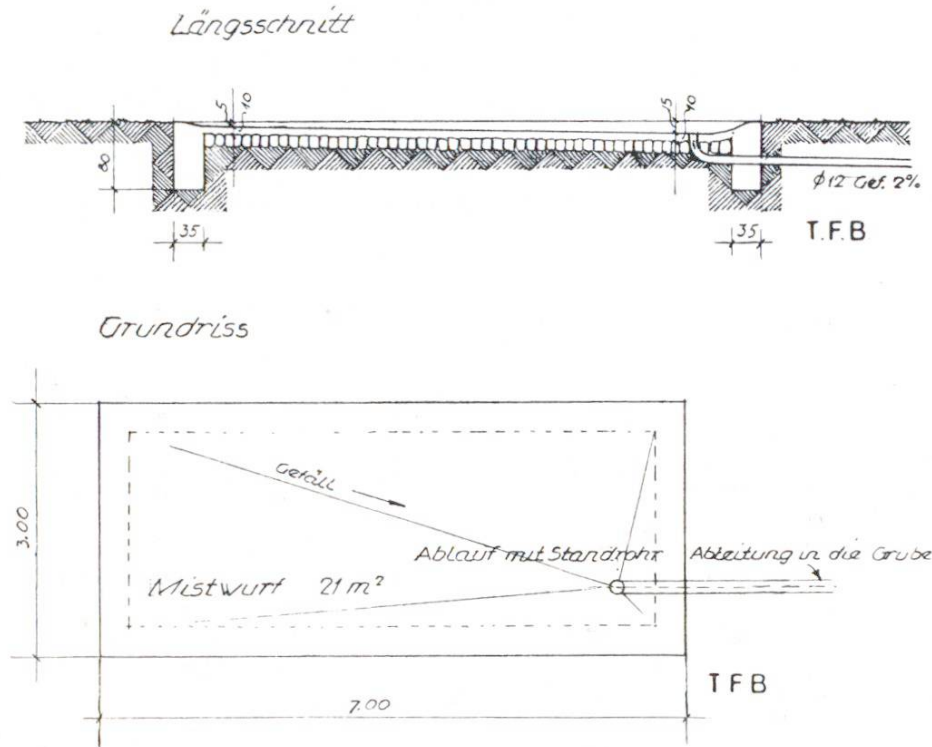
und 6 Mistwurf von 21 m² Fläche, Längsschnitt und Grundriss
